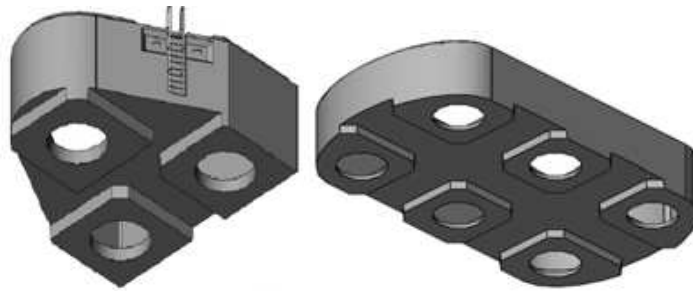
Exemples de coques préfabriquées en béton. ©photothèque BYTP
